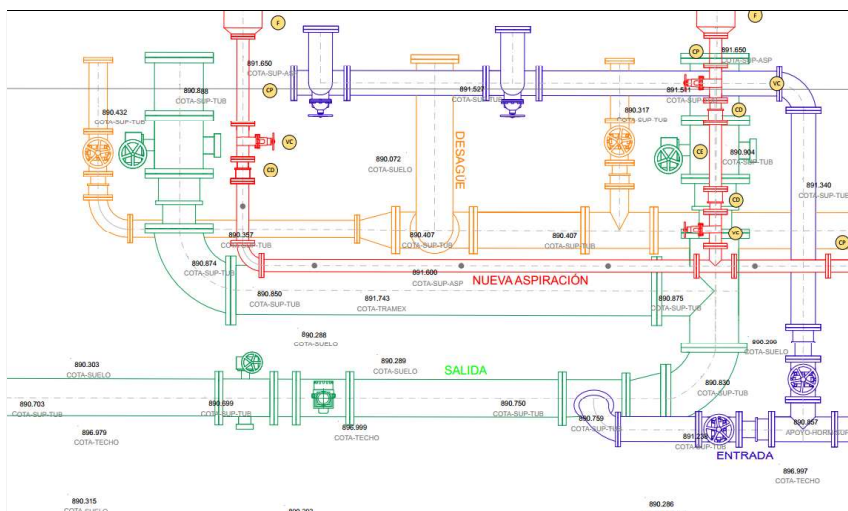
Planta de la sala de válvulas con la nueva tubería de aspiración.
